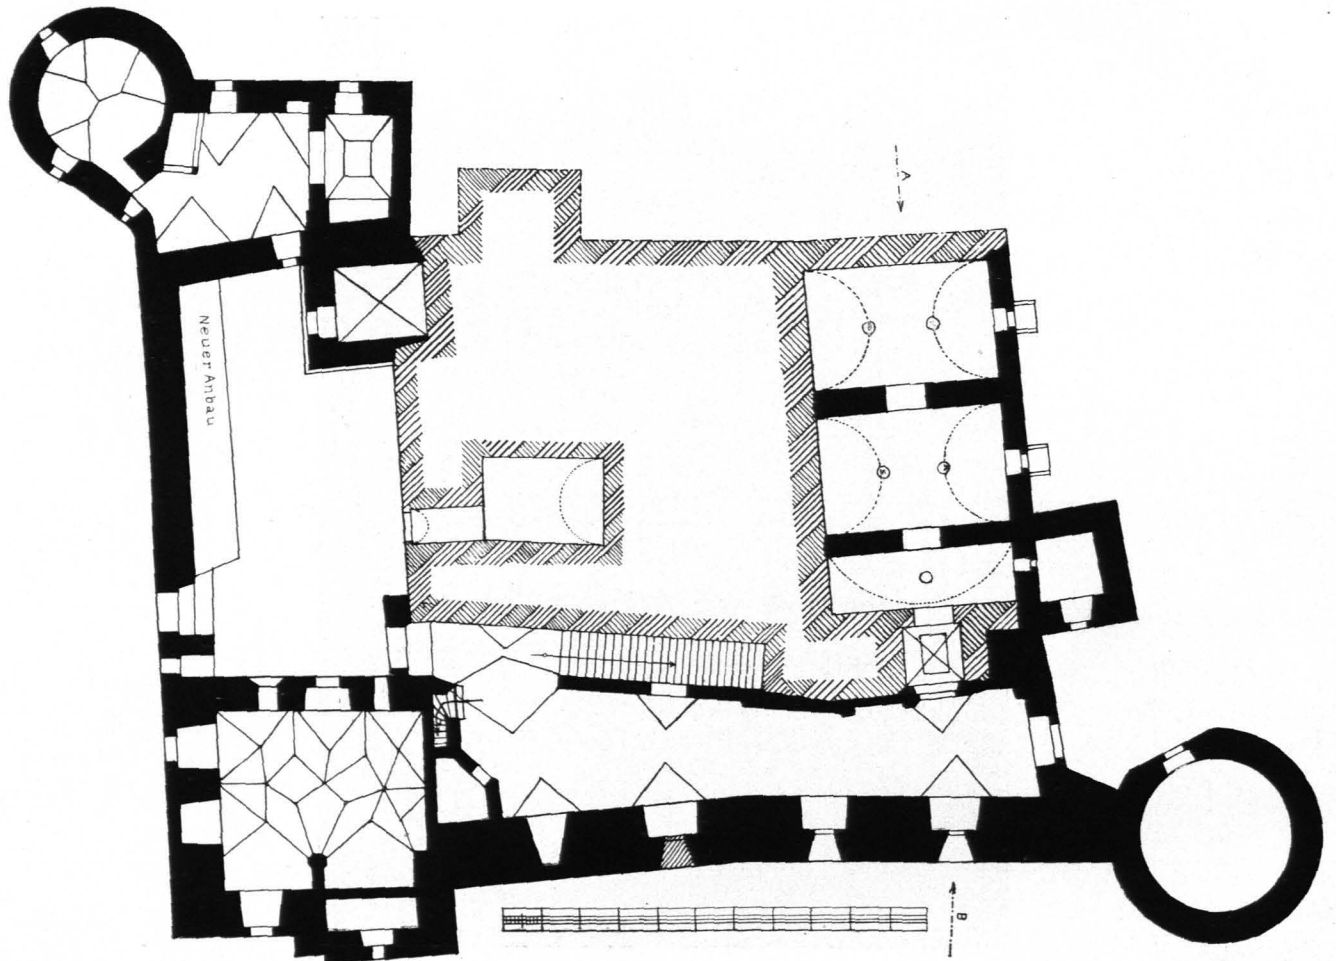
Hohensalzburg, altes Schloß, Erdgeschoß, Grundriß 1 : 200 (S. 104)
